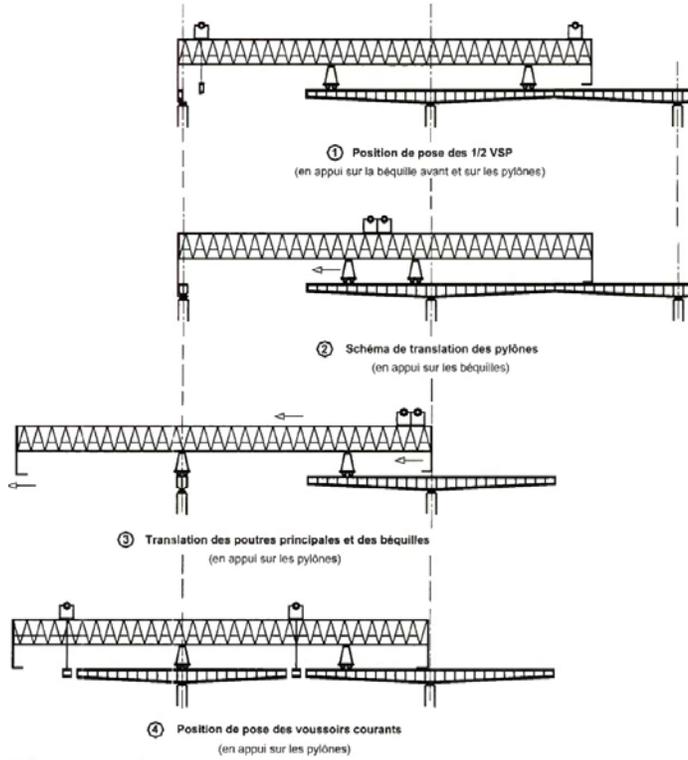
Poutre de lancement – Pont de l'Île de Ré
